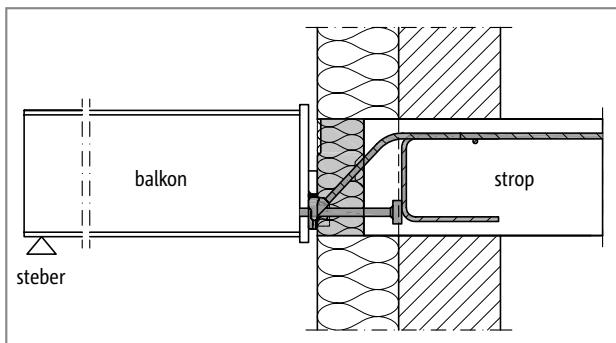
Schöck Isokorb® T tip SQP: priključek na železobetonski strop; monolitna konstrukcija stene
